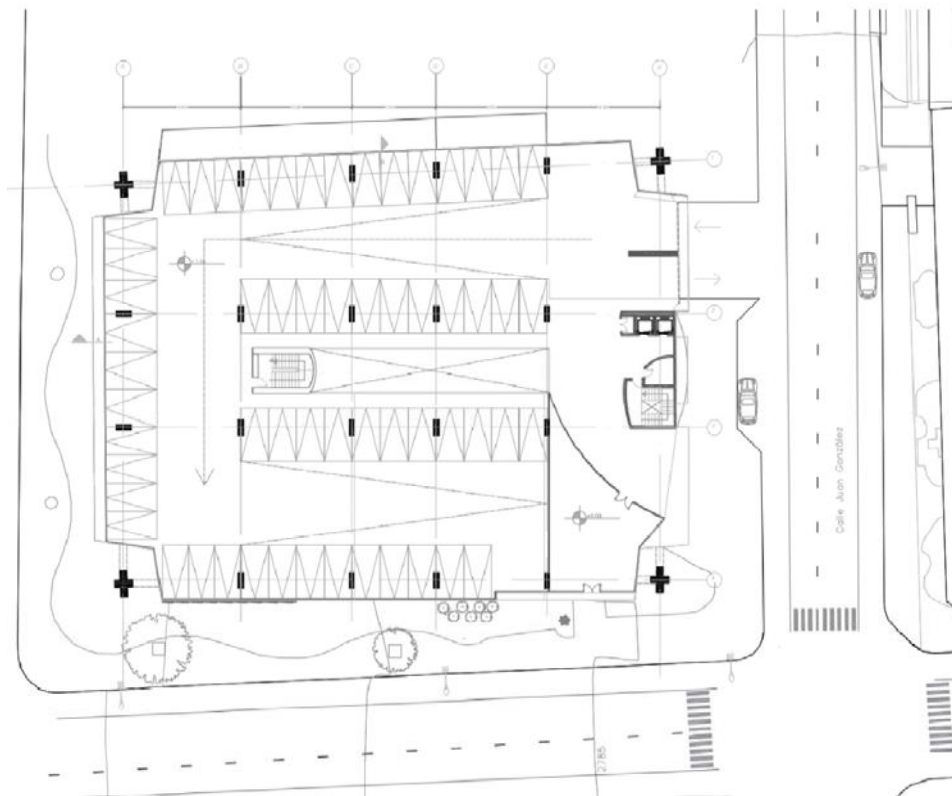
Planta Baja estado actual. Elaboración propia, basado en el levantamiento del edificio existente.
